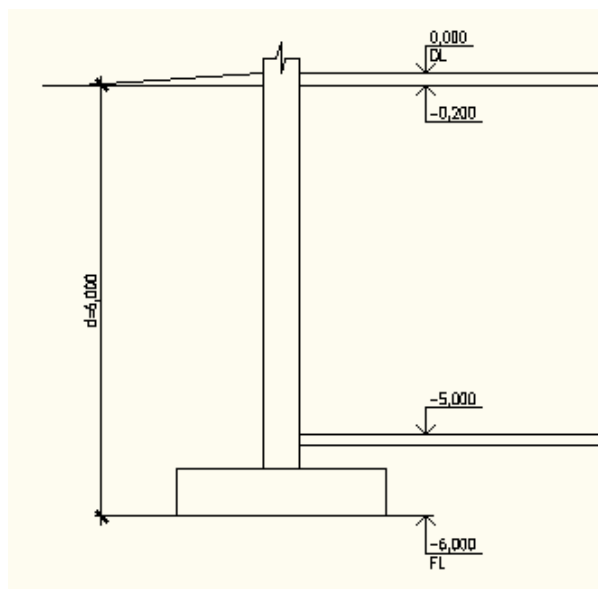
Схема к назначению глубины заложения подошвы фундамента
